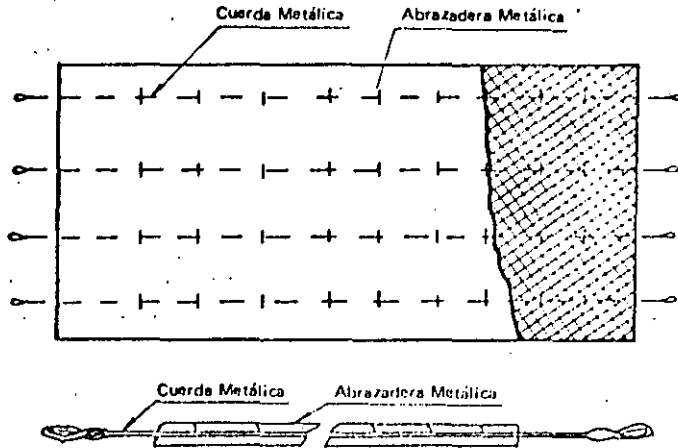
Ejemplo de la estructura de estera asfáltica
